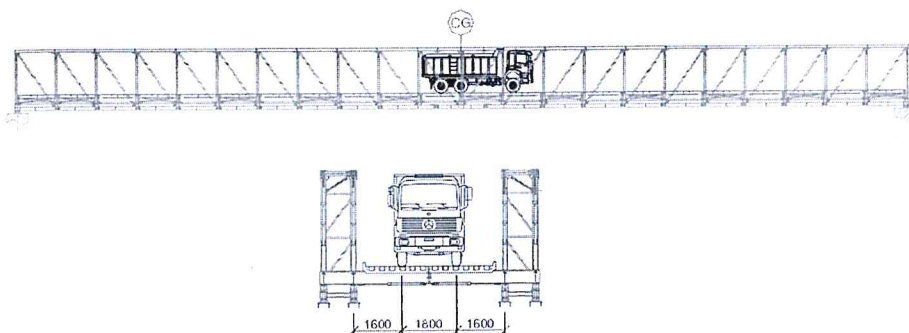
POSICIÓN DE LA CARGA DEL ENSAYO (ALZADO Y CORTE TRANSVERSAL)
